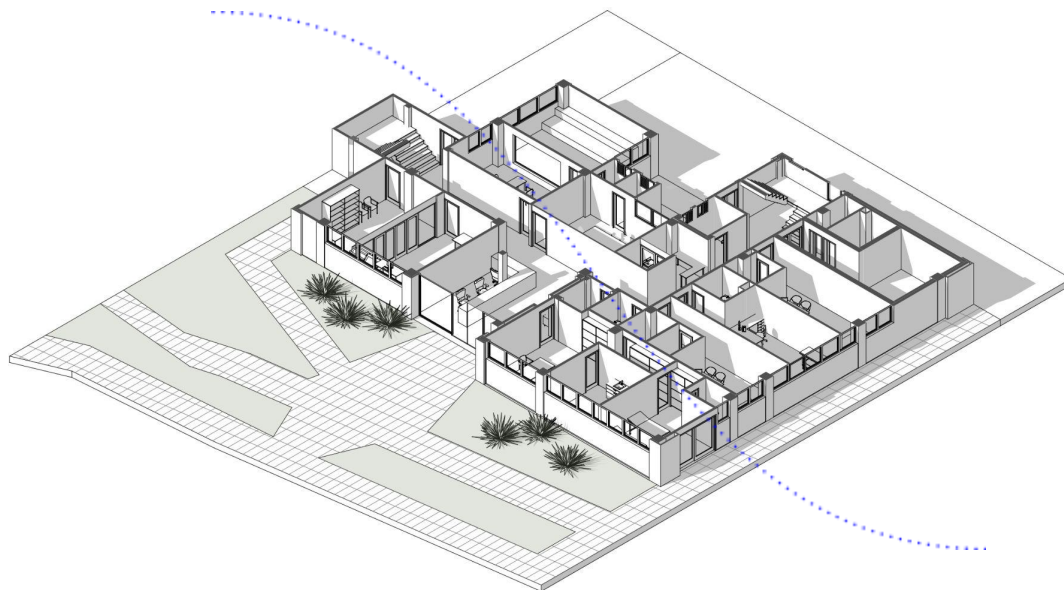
Diagrama de ventilación planta baja del edificio (LEVANTAMIENTO 3D “EDIFICIO UDA SALUD)
